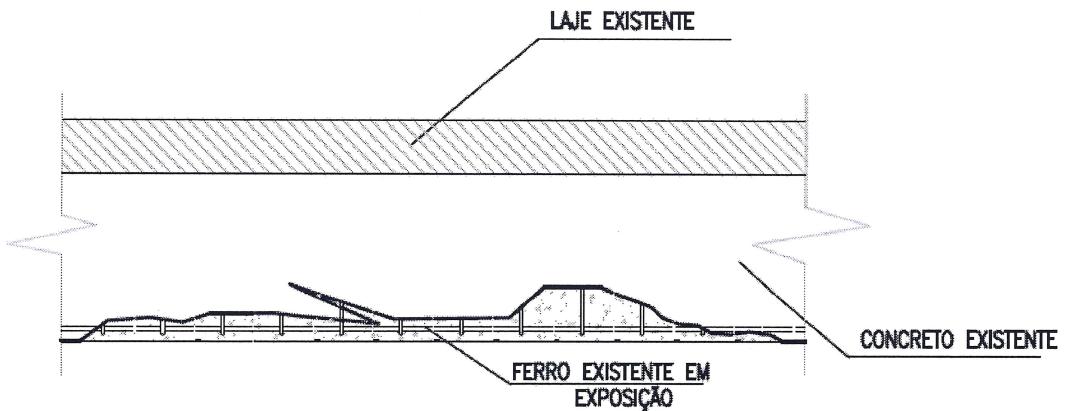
Recomposição de laje ou viga (Demolição do concreto segregado)
